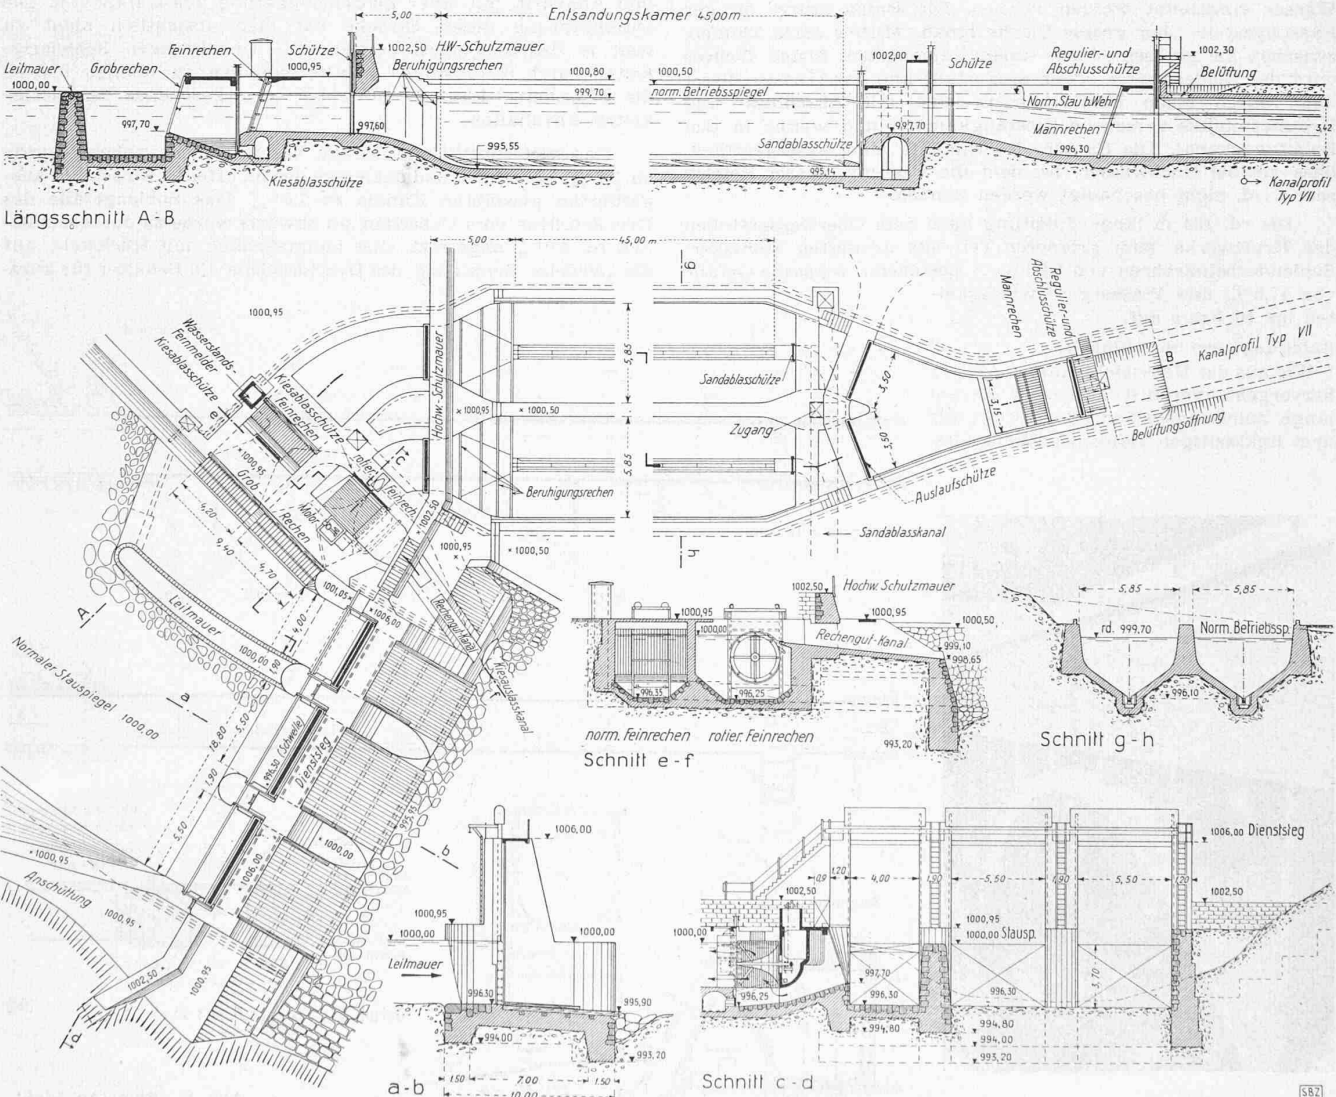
Grundriss und Schnitte von Wehr, Fassung und Entsander. — Masstab 1 : 400
